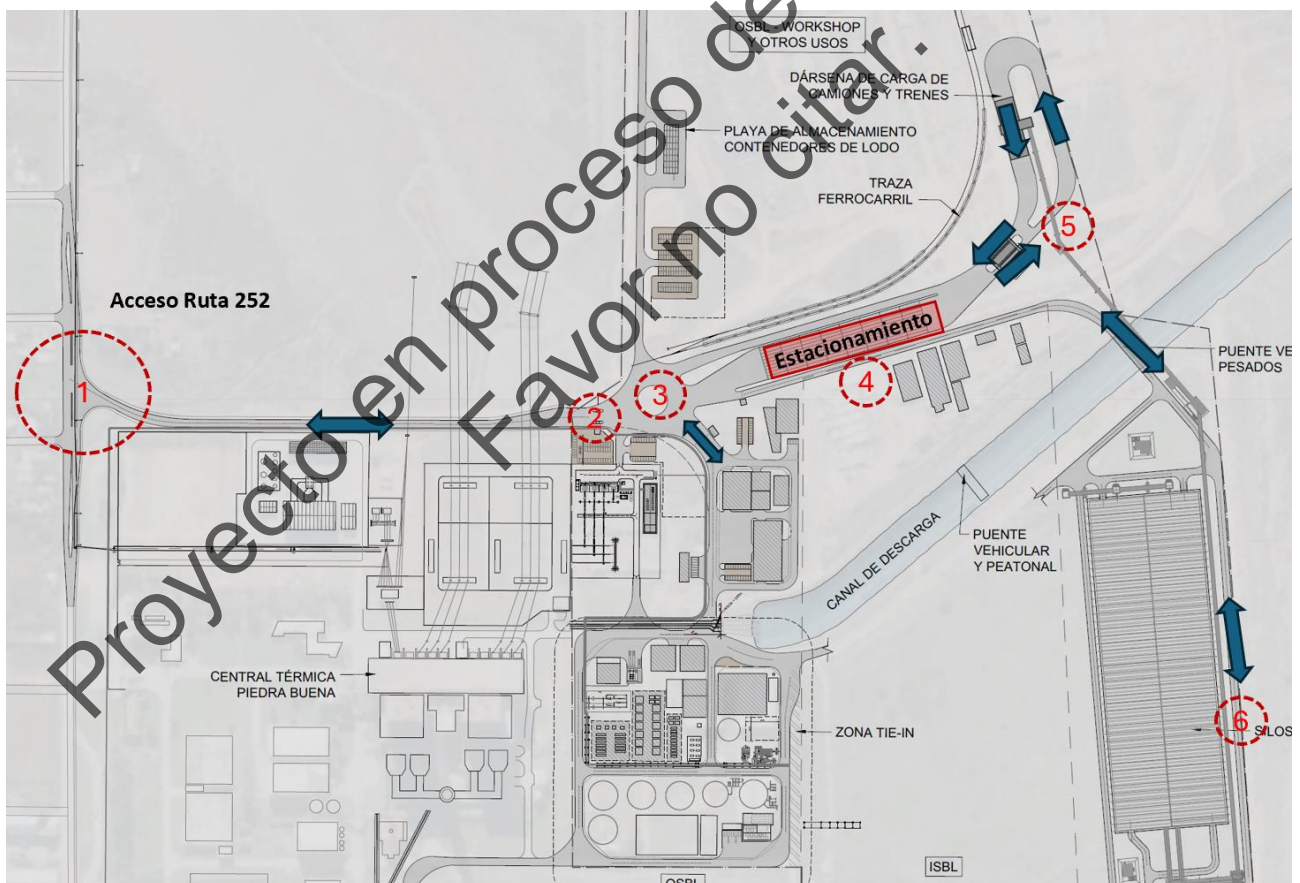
Lay out de la planta de fertilizantes: Sectores relevantes. Referencias: 1) dársenas de giro en vinculación con RN 252, 2) Puestos de control de acceso. 3) Rotonda de distribución. 4) Sector de estacionamiento para camiones. 5) Acceso a dársenas de carga. 6) Camino de vinculación con el muelle de cargas.
